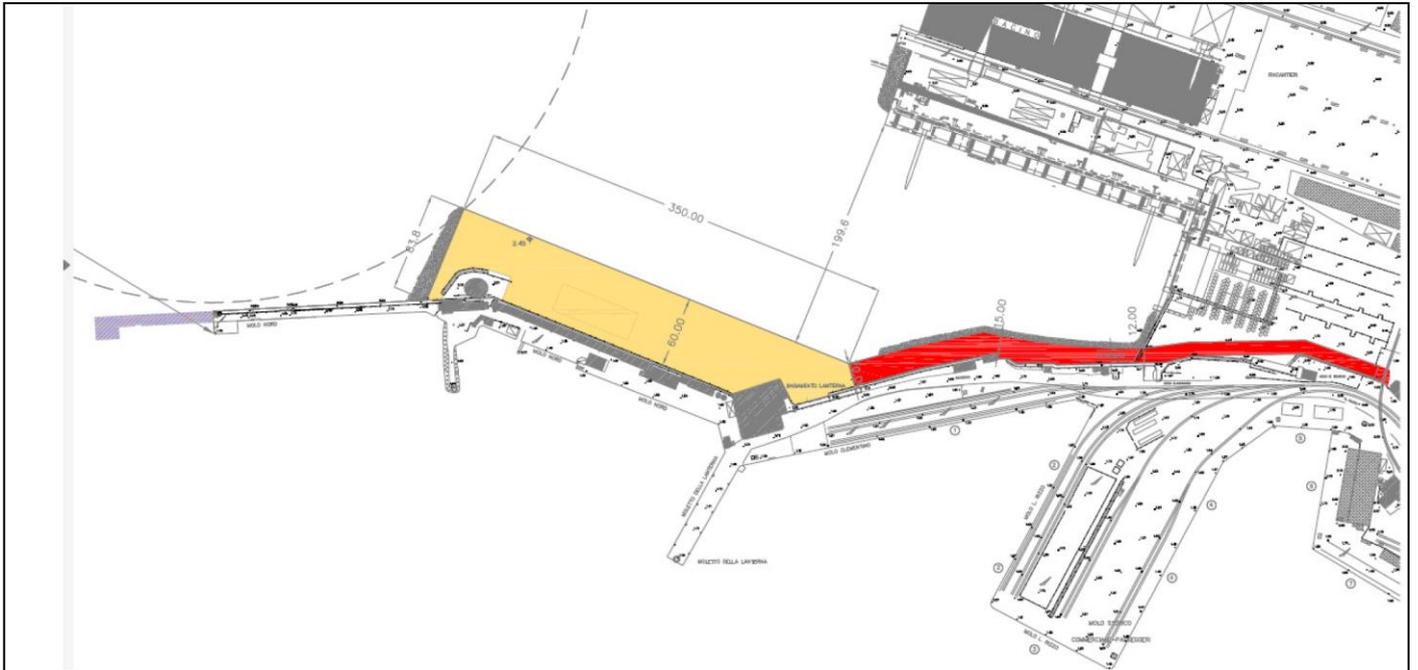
Planimetria generale di progetto SOLUZIONE 1 senza risolto.
